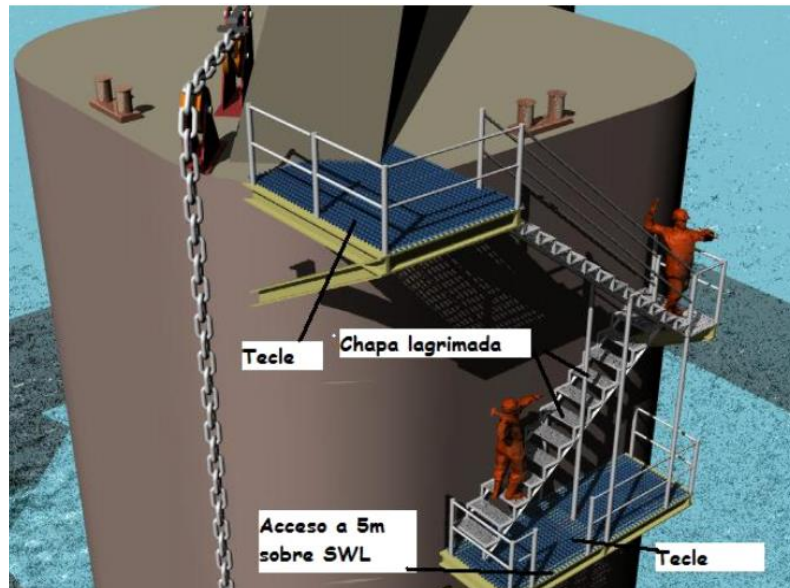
Escalera de acceso exterior a la columna, TFT.
